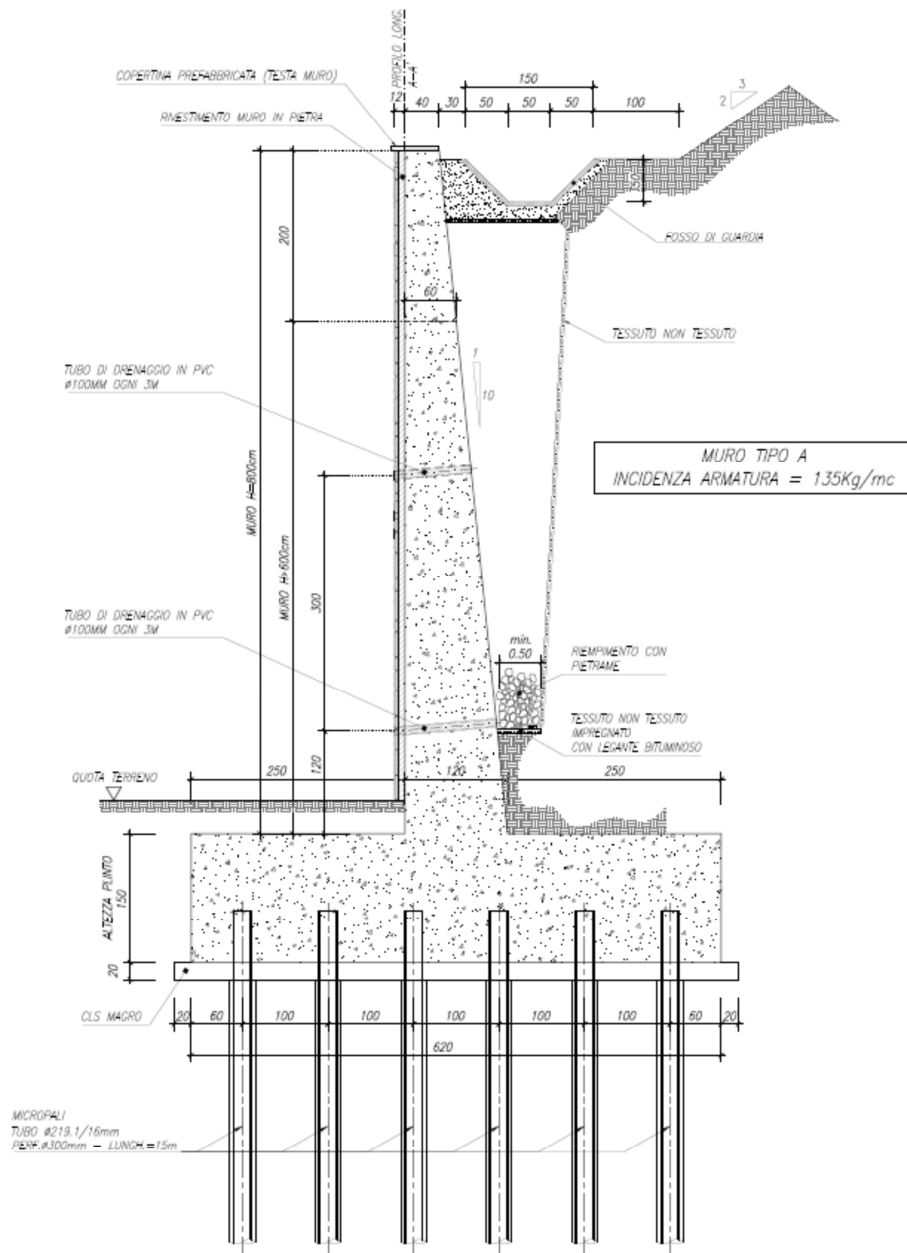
Muro Asse 3 e Asse 5: sezione tipologica.
